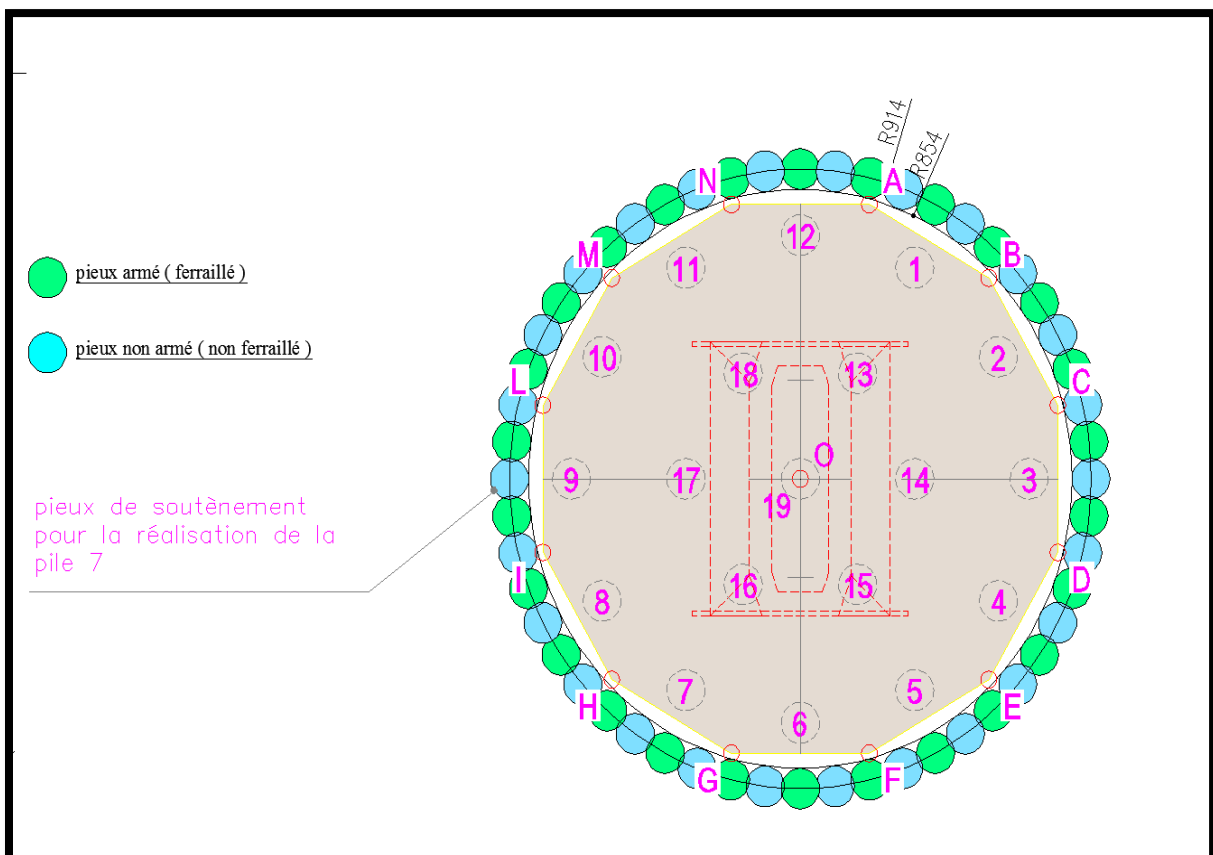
Vue en plan des pieux sécants pour la réalisation de la pile 7
